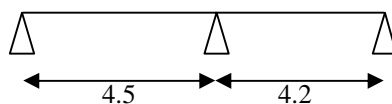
Schéma du 3<sup>ème</sup> type de poutrelle
